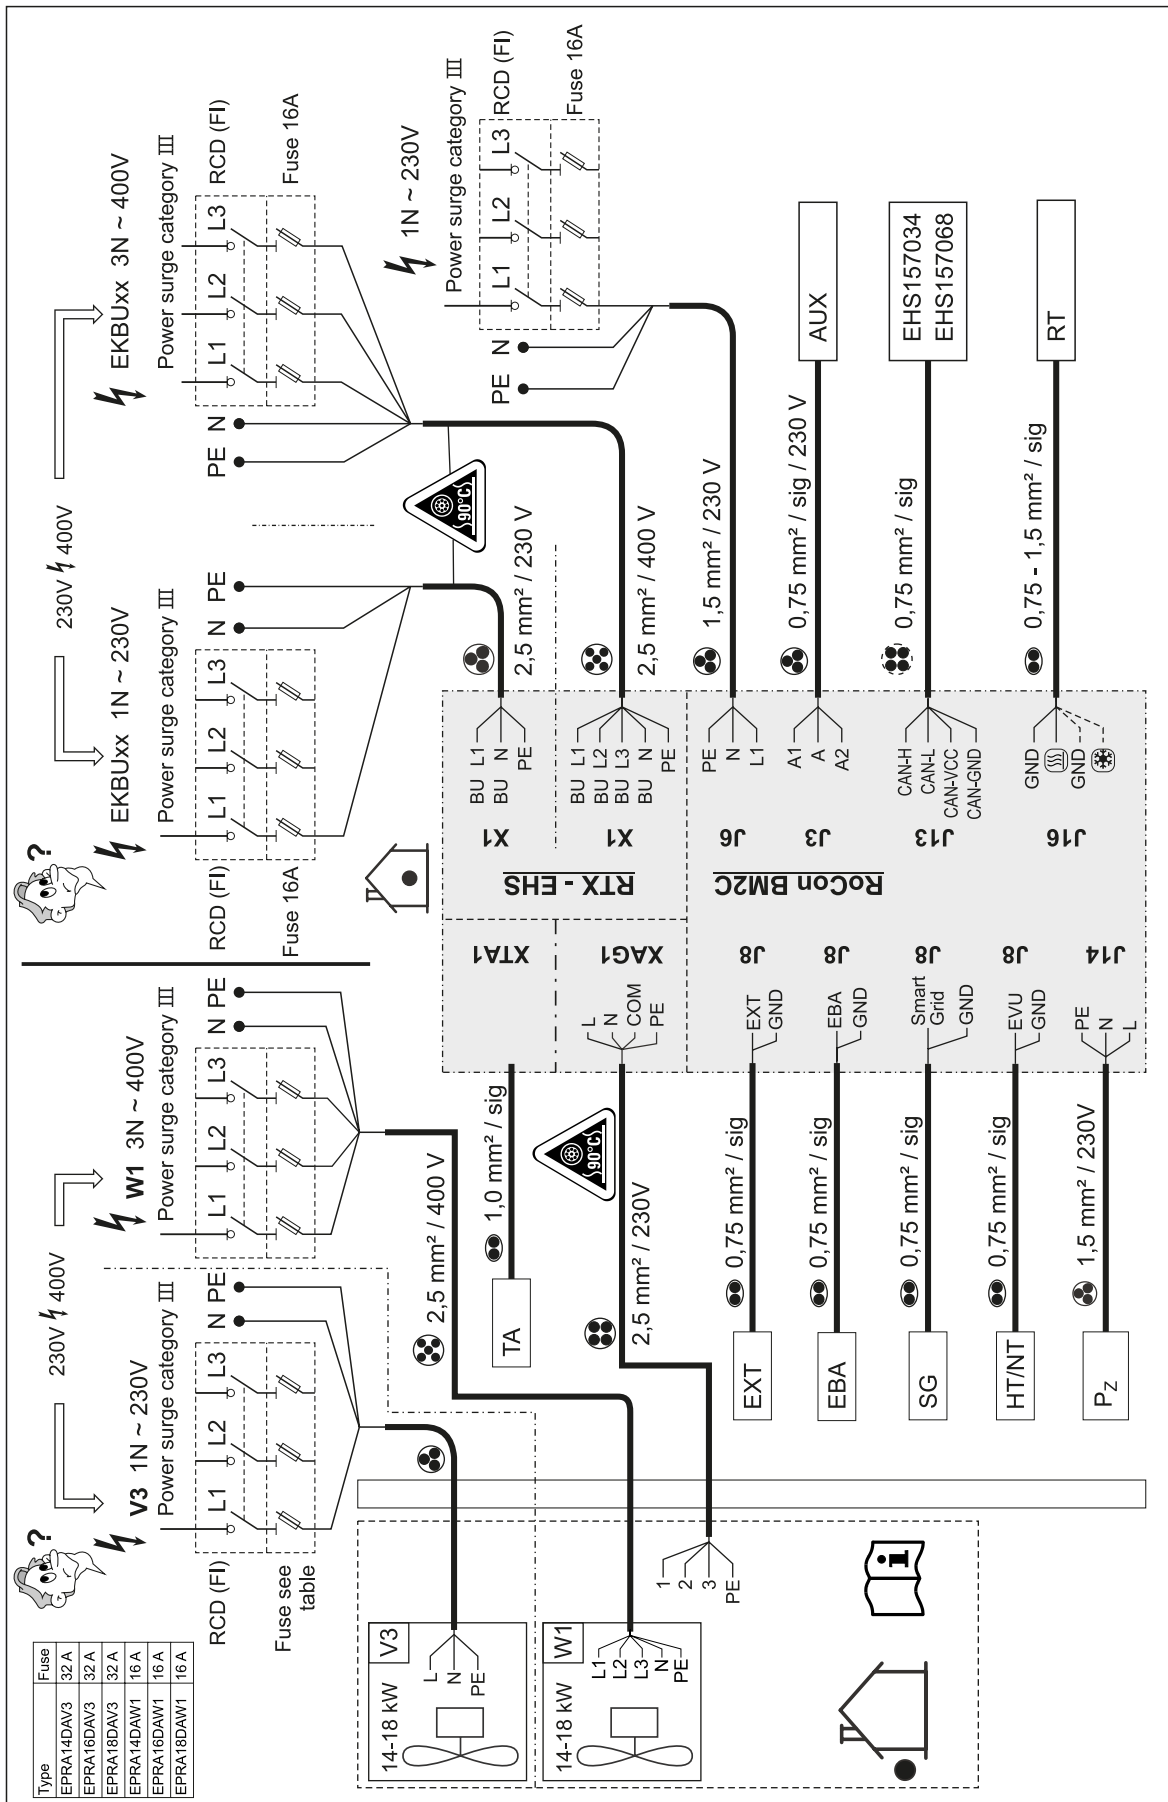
Gesamtanschlussplan - für den elektrischen Anschluss bei der Geräteinstallation (Legende und Anschlussbelegung der Schaltplatine siehe Kap. 6.3)
